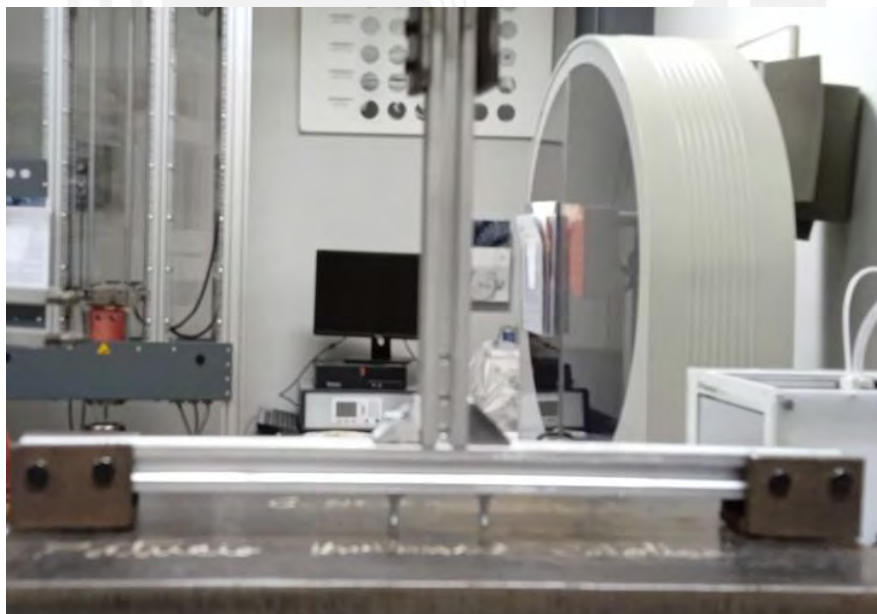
Ensamble de la quinta prueba con tornillos pasantes. Fuente: Propia.
